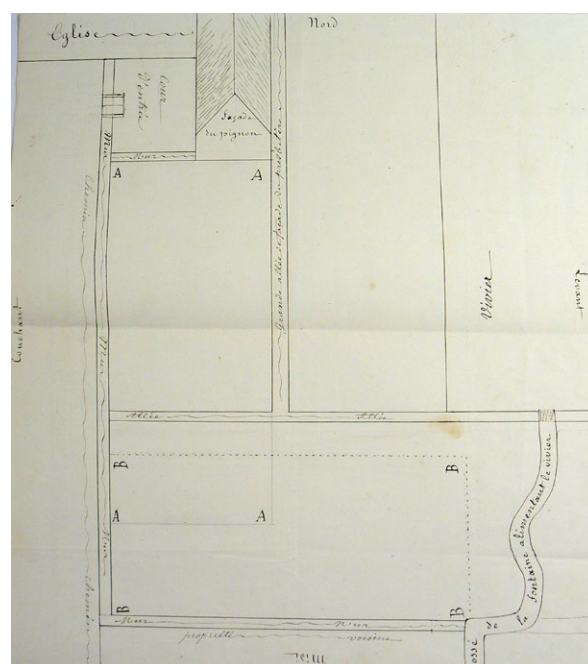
croquis en plan domaine du presbytère de Joué-lès-Tours en 1853 (ADIL 1Ø122/49)
